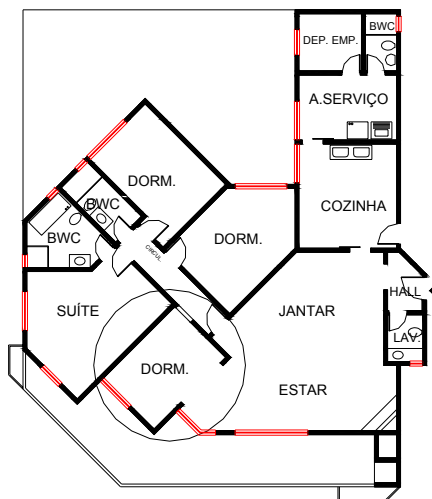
Planta Baixa do apartamento 601 - Estudo de caso C.
